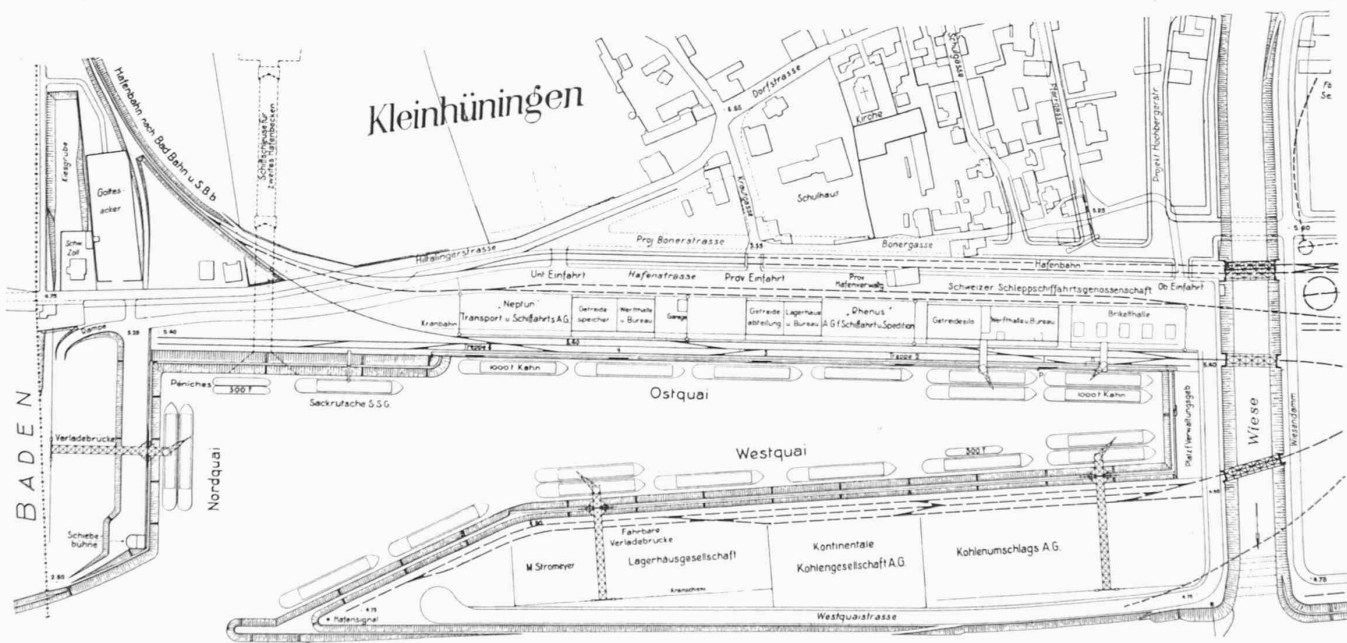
Lageplan 1:4500 des Hafenbeckens Kleinhüningen (gestrichelte Geleise im Bau).
